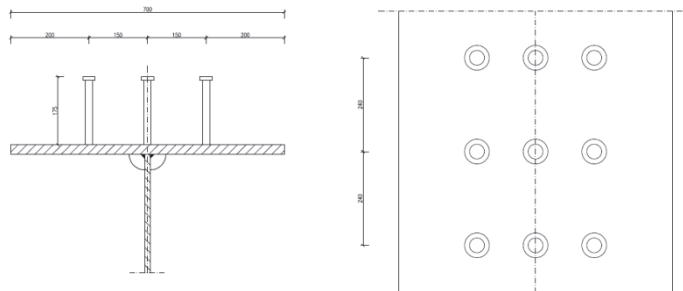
9- Dettaglio 3 della tavola allegata "Carpenterie metalliche-impalcati sezioni tipologiche 3", disposizione connettori trave-soletta del viadotto Molona
